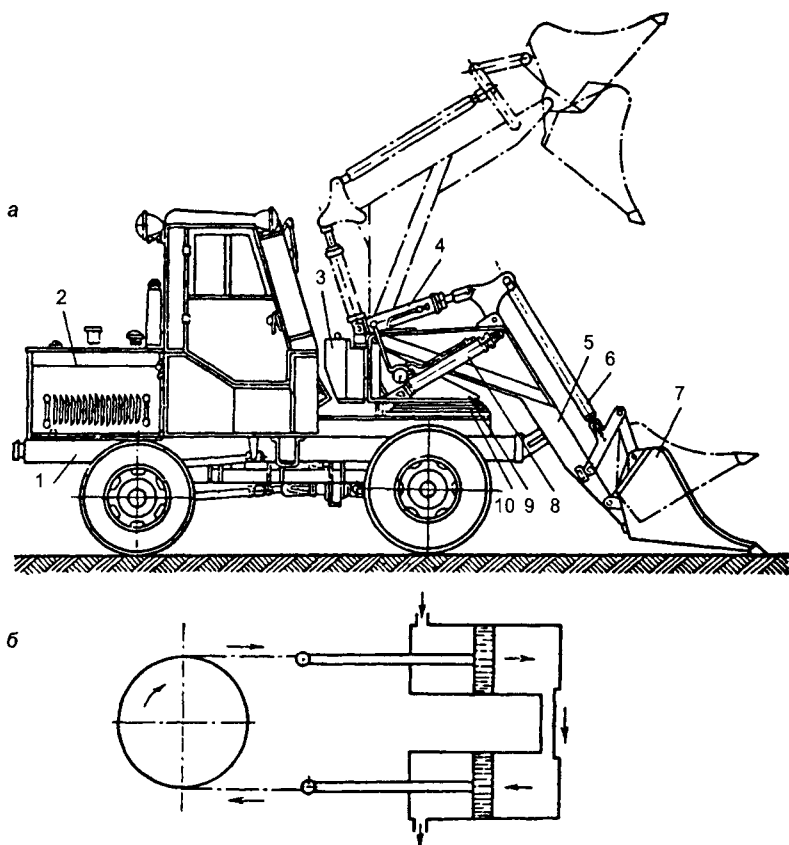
Полуповоротный одноковшовый погрузчик:
